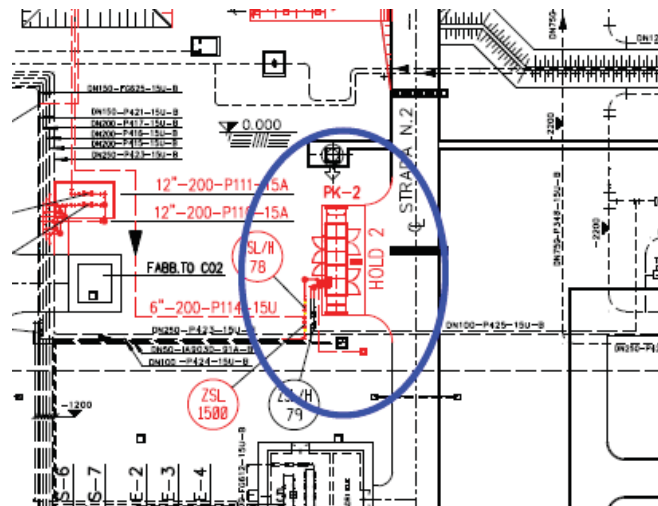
Stralciamento planimetrico compressore recupero gas
